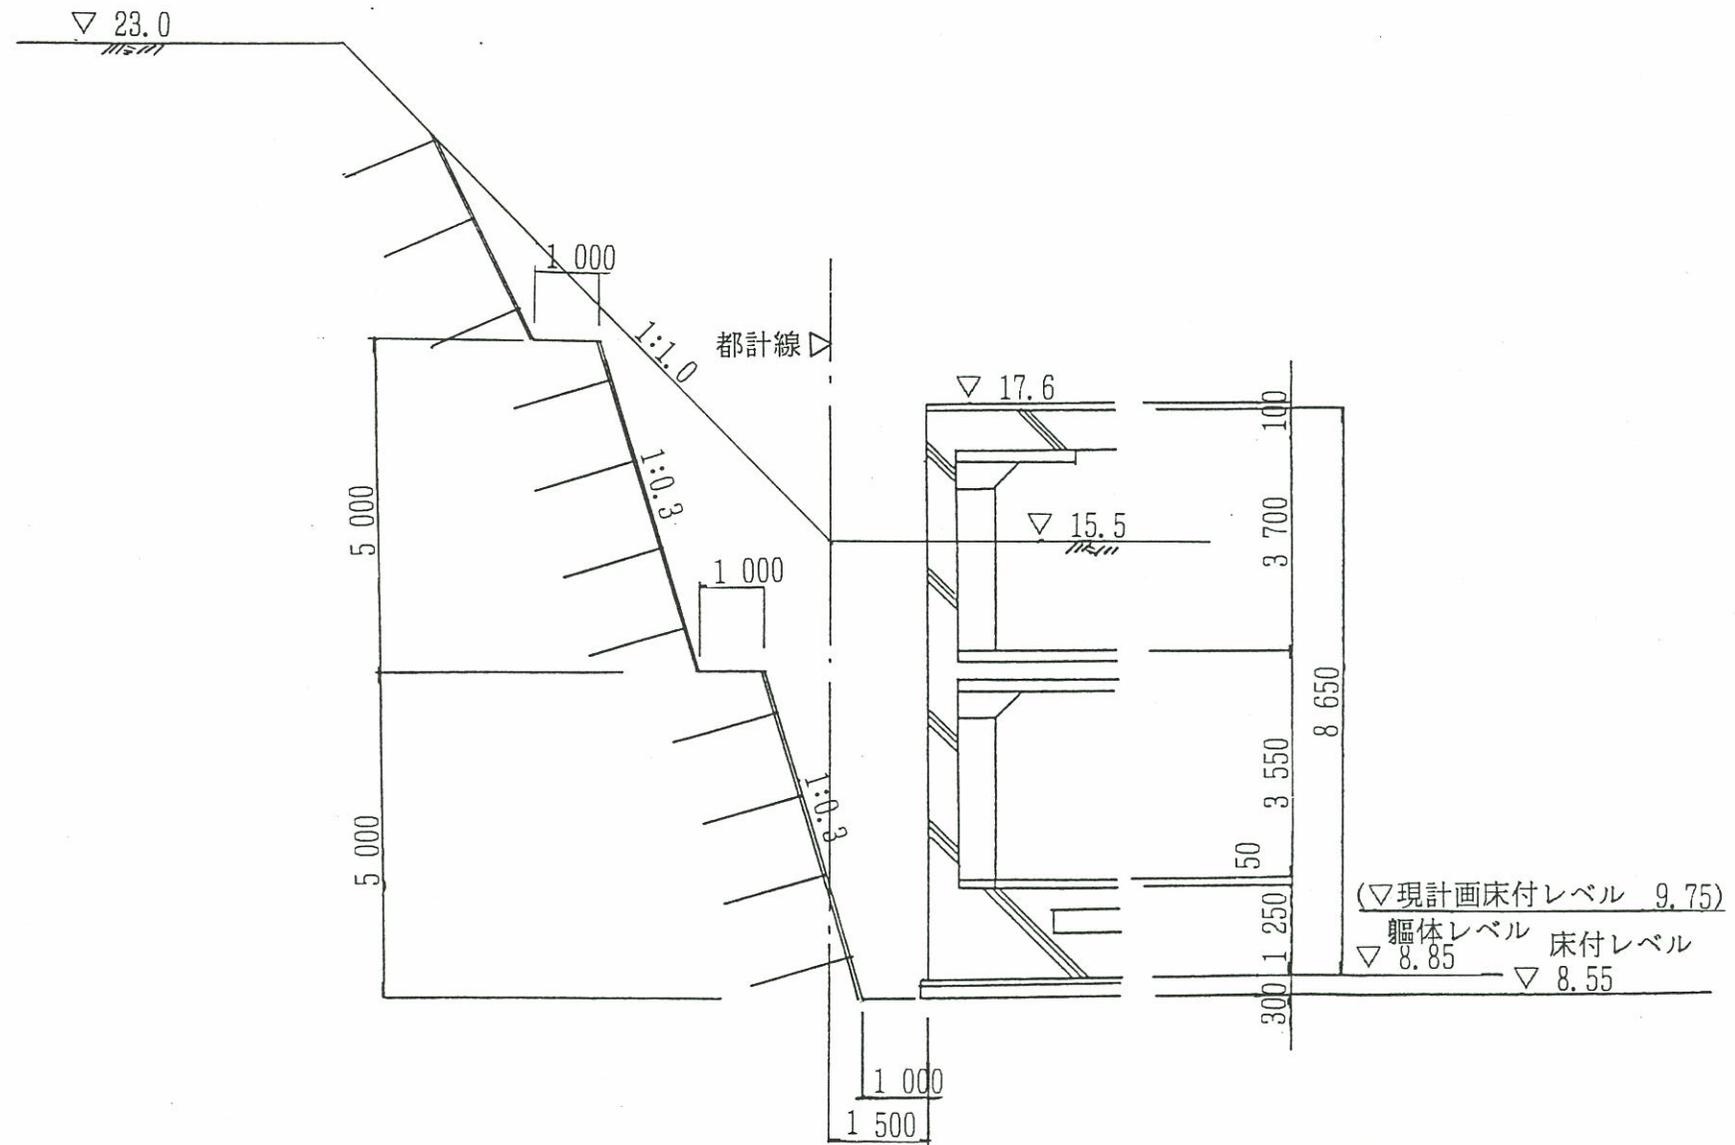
土取計画断面図 (④-④)
